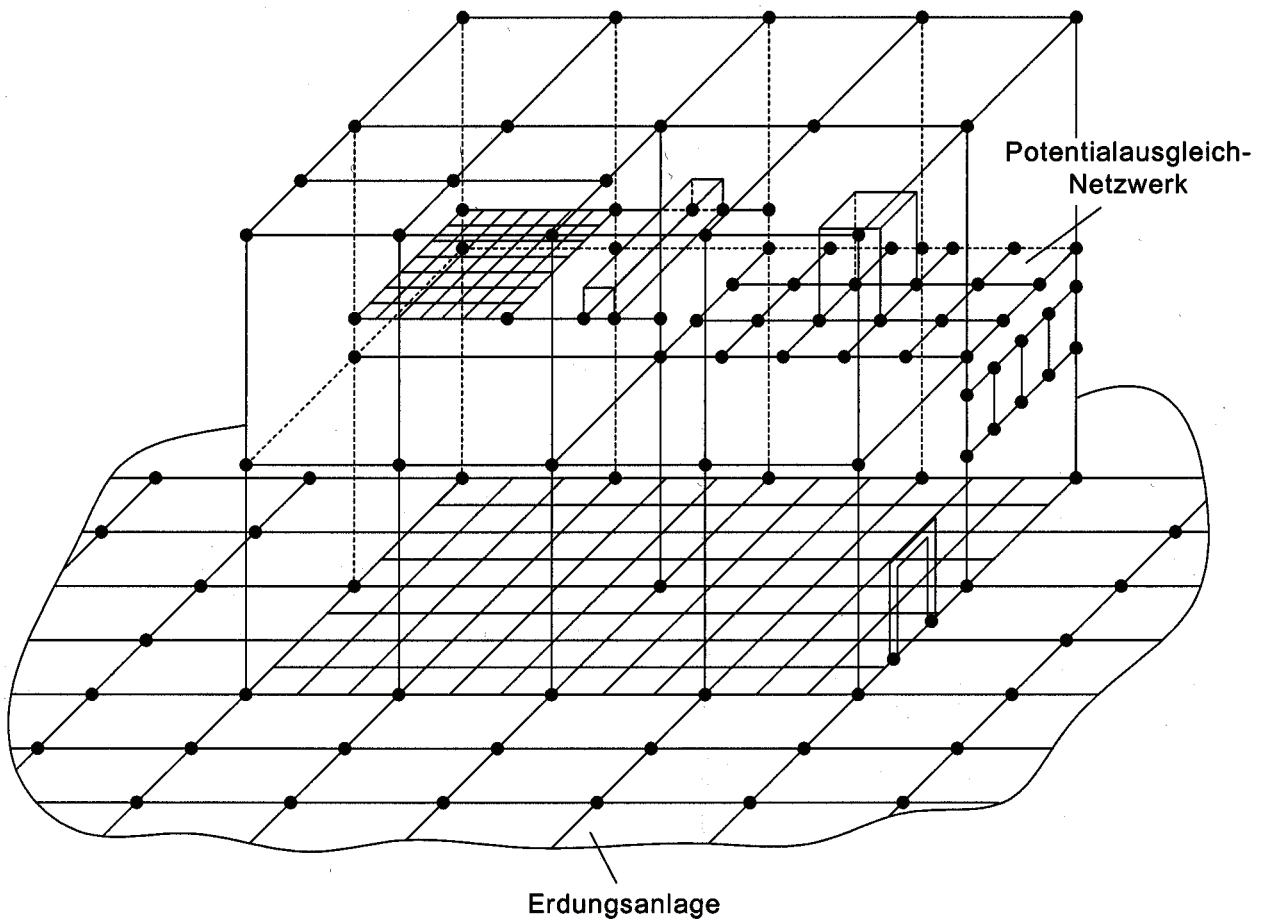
Verwendung der Armierungsstäbe einer baulichen Anlage für den Potentialausgleich
